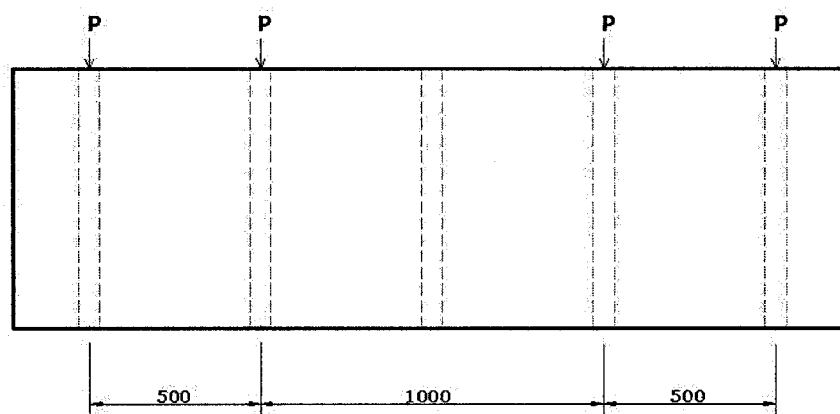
Schéma des forces s'appliquant sur la semelle dans la direction secondaire
